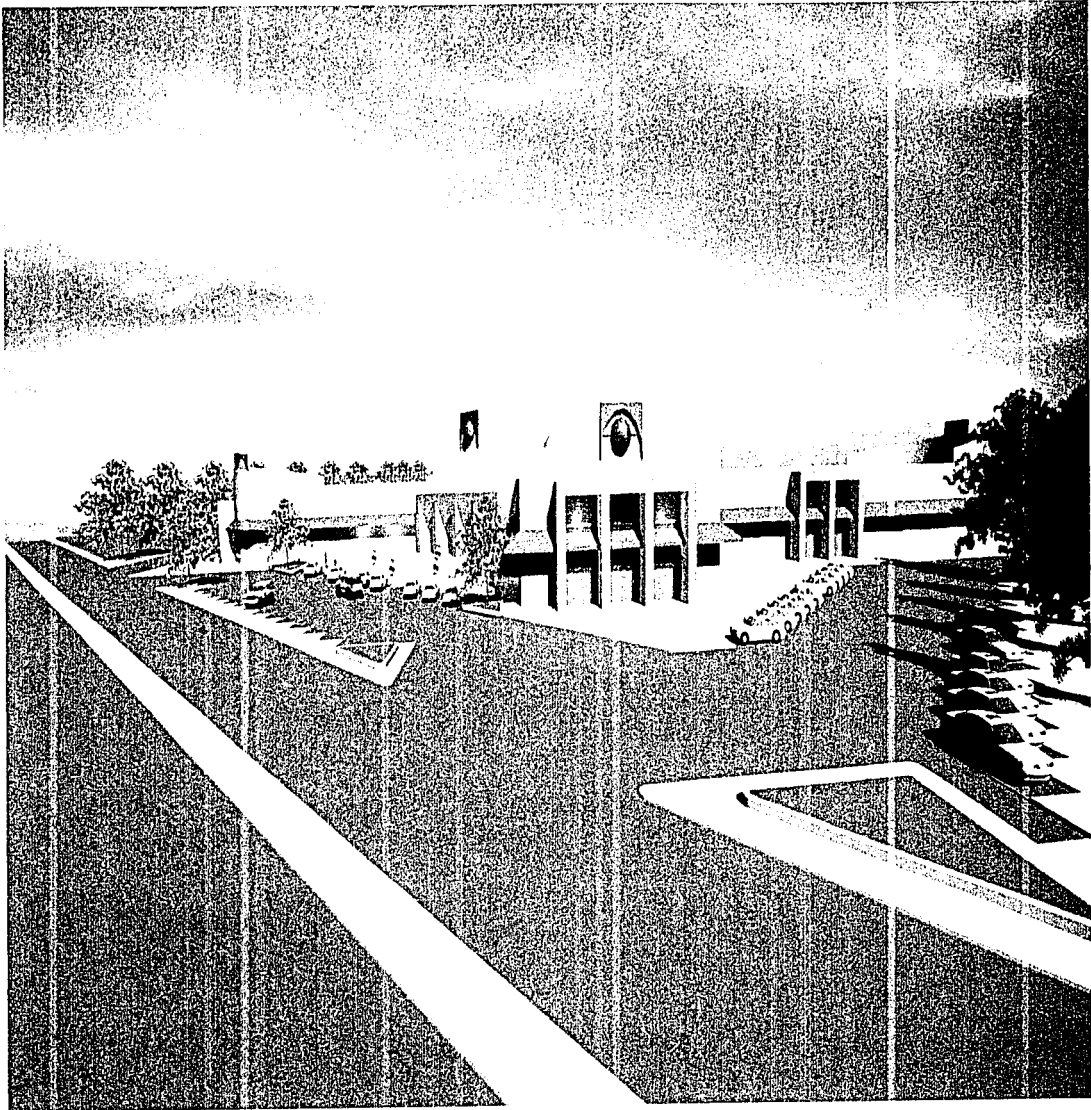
VISTA ESTACIONAMIENTO DE MERCADO NORTE
